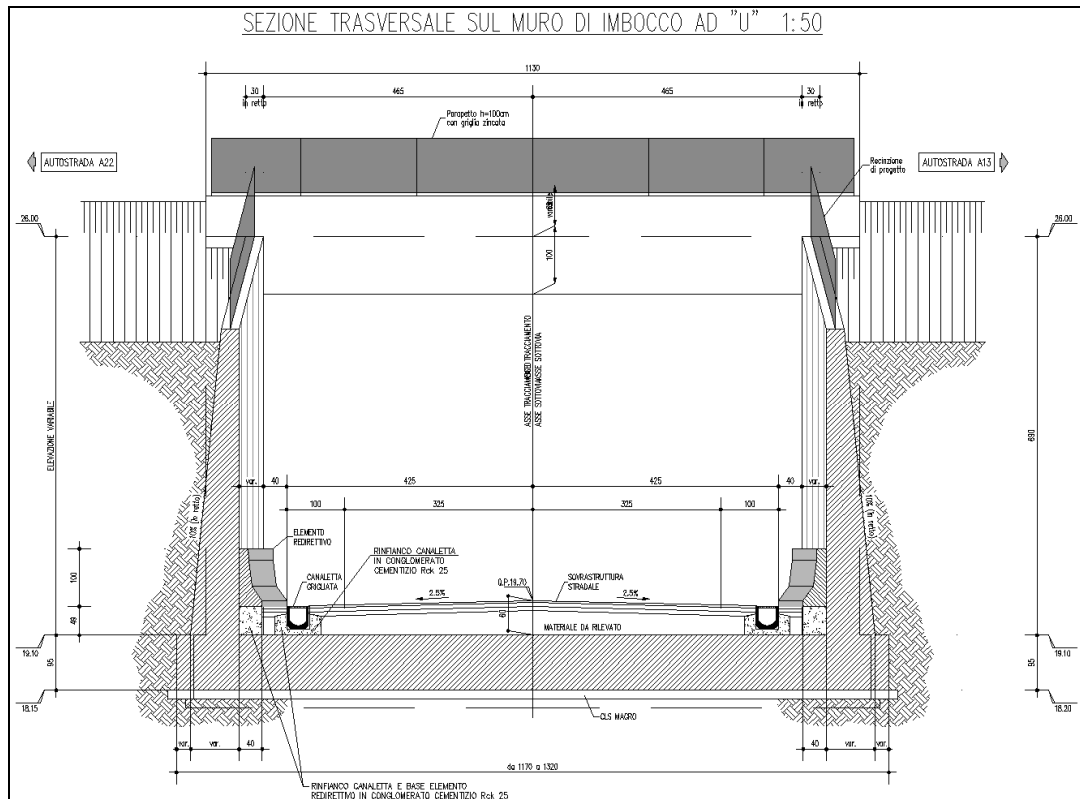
SEZIONE TRASVERSALE SUL MURO DI IMBOCCO AD "U"
